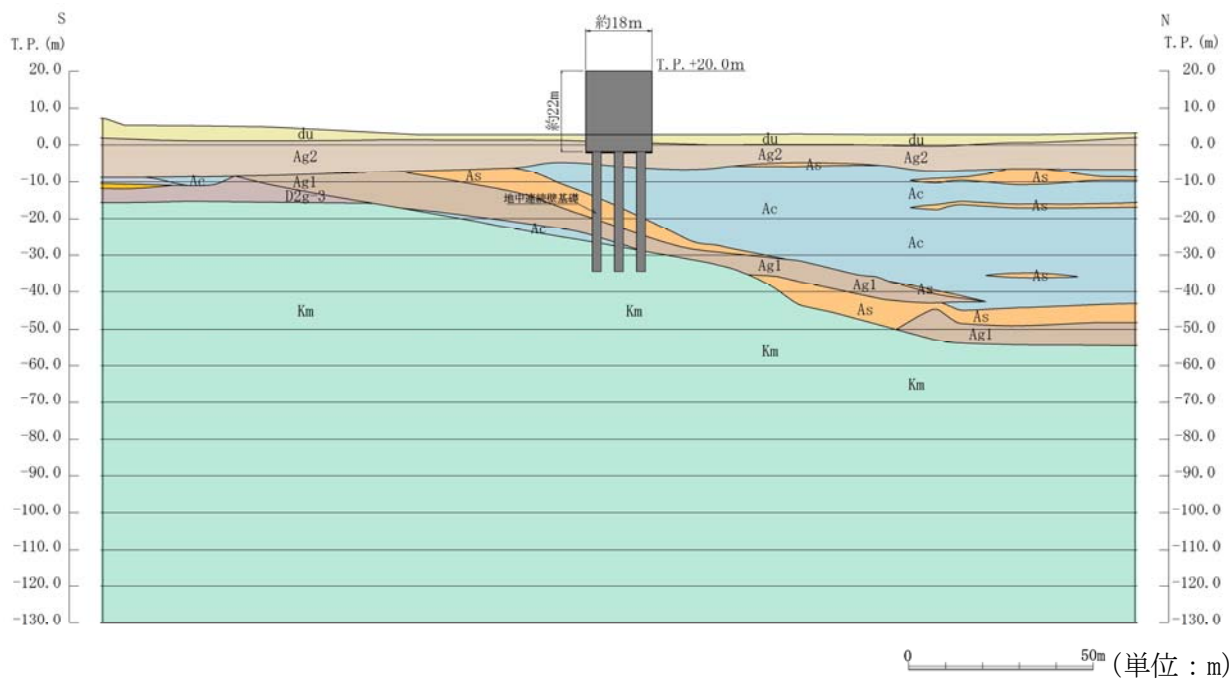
(3) 鉄筋コンクリート防潮壁 評価対象断面図 (③-③断面)
